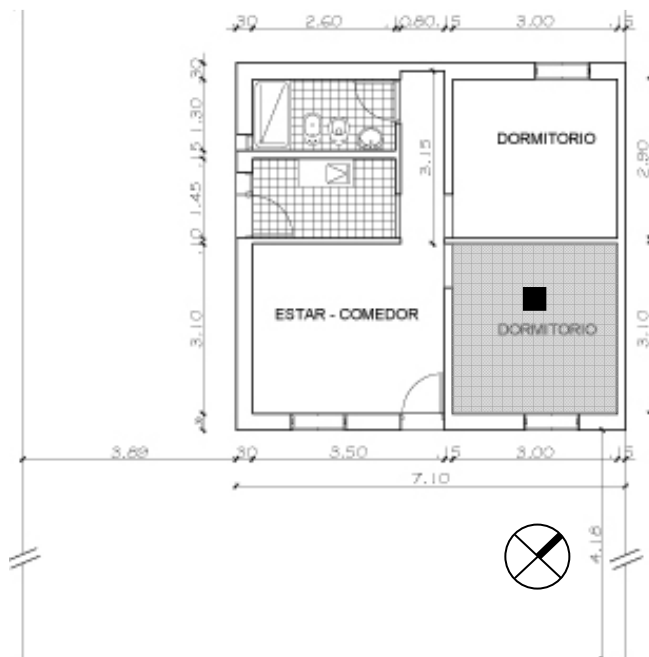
Planta de vivienda Banco Hipotecario Nacional.
